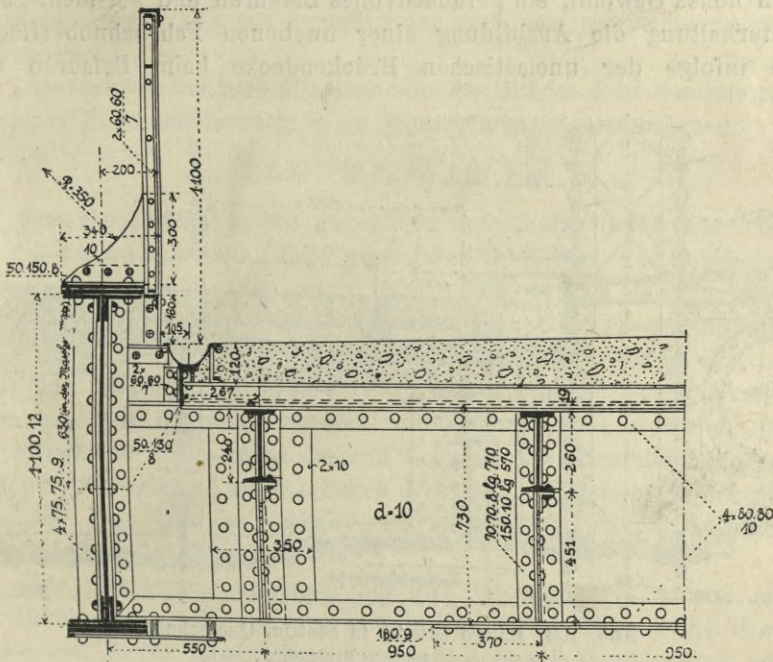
Querschnitt einer Straßenbrücke mit Schotterdecke.
